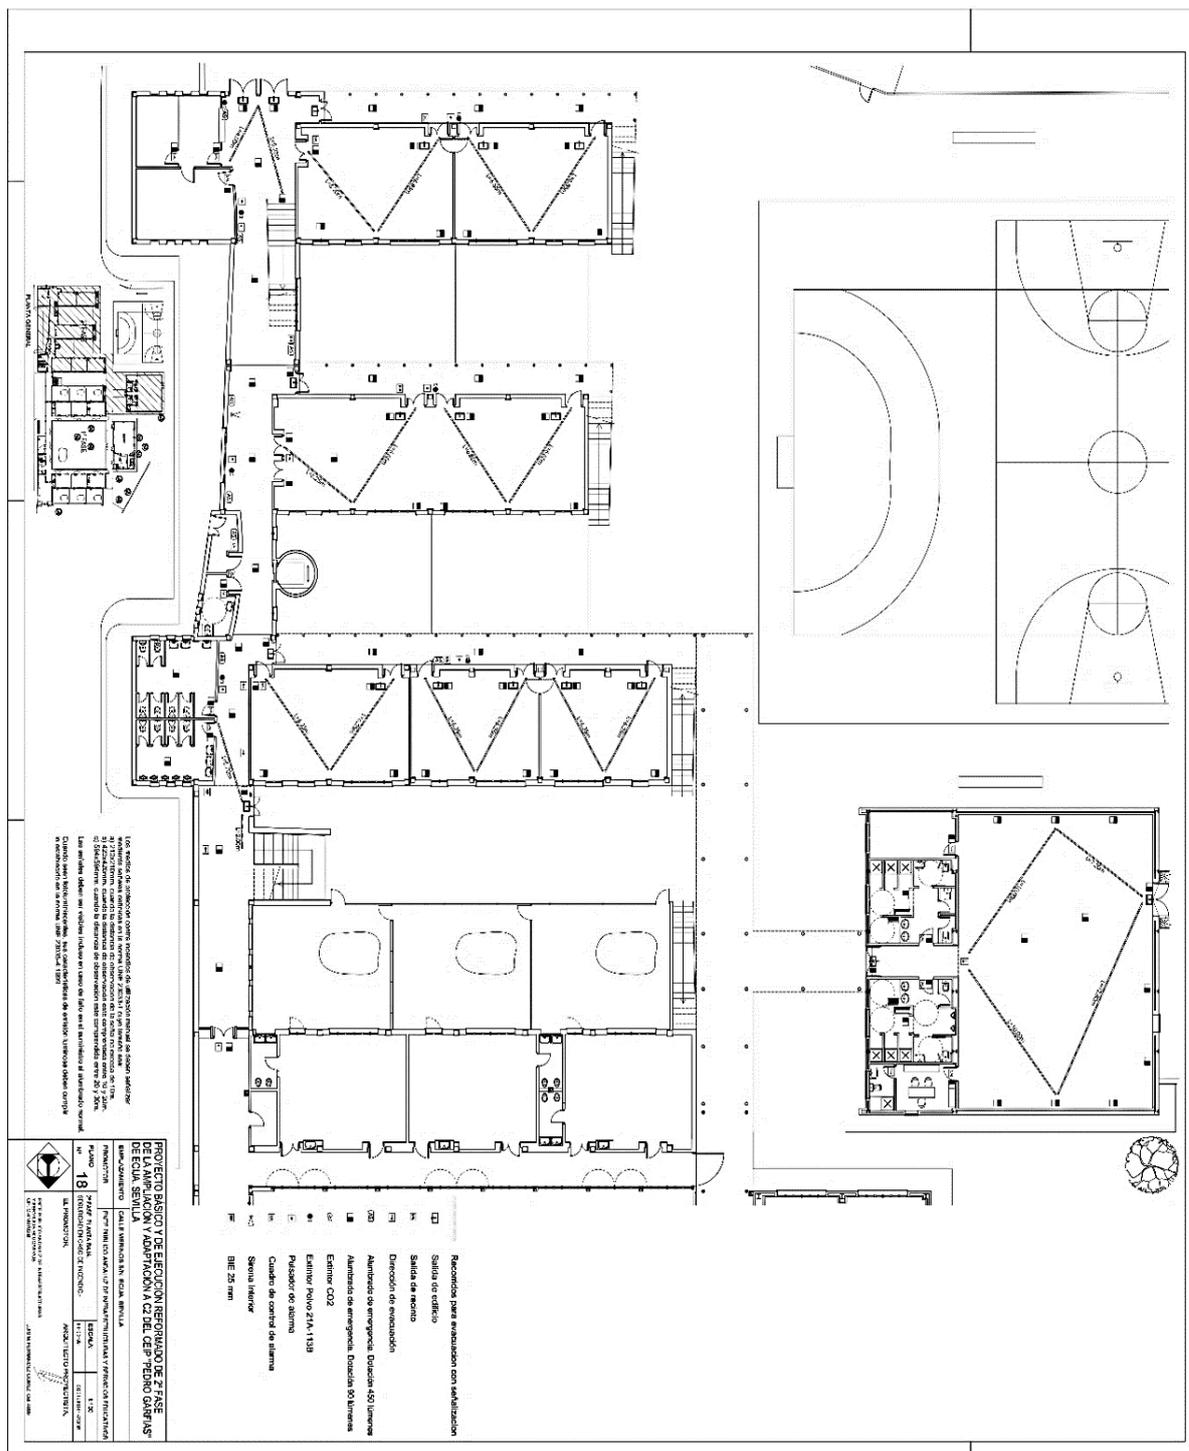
Plano Emergencia. EDIFICIO DE PRIMARIA -PLANTA BAJA-
